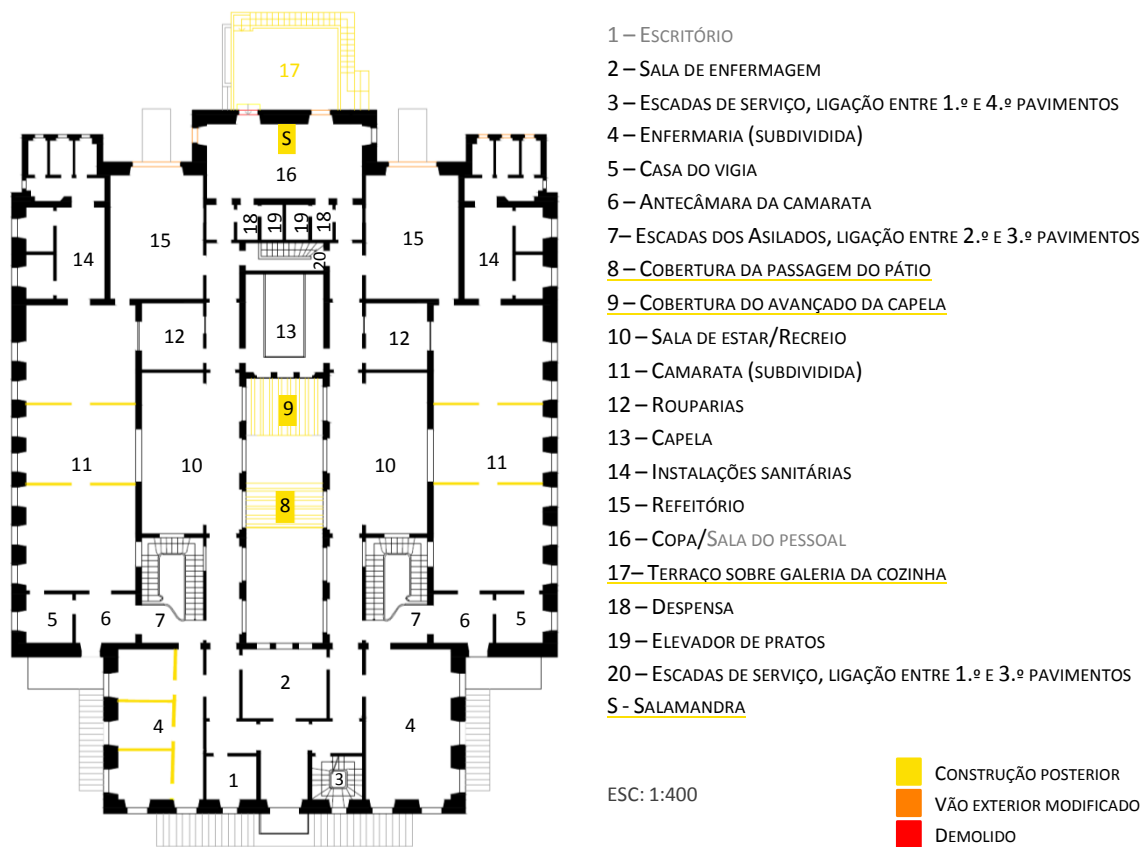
Proposta de reconstituição do 3.º pavimento, em 1916
